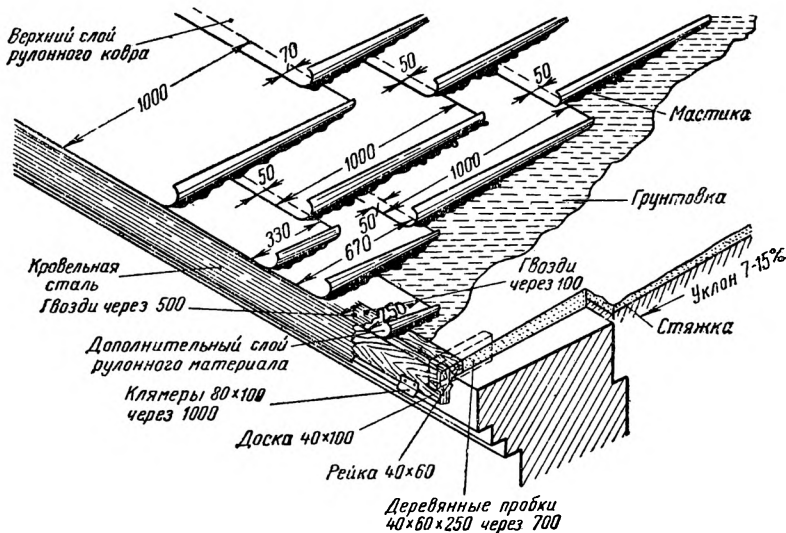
Трехслойный рулонный ковер на уклонах кровли от 7 до 15%
